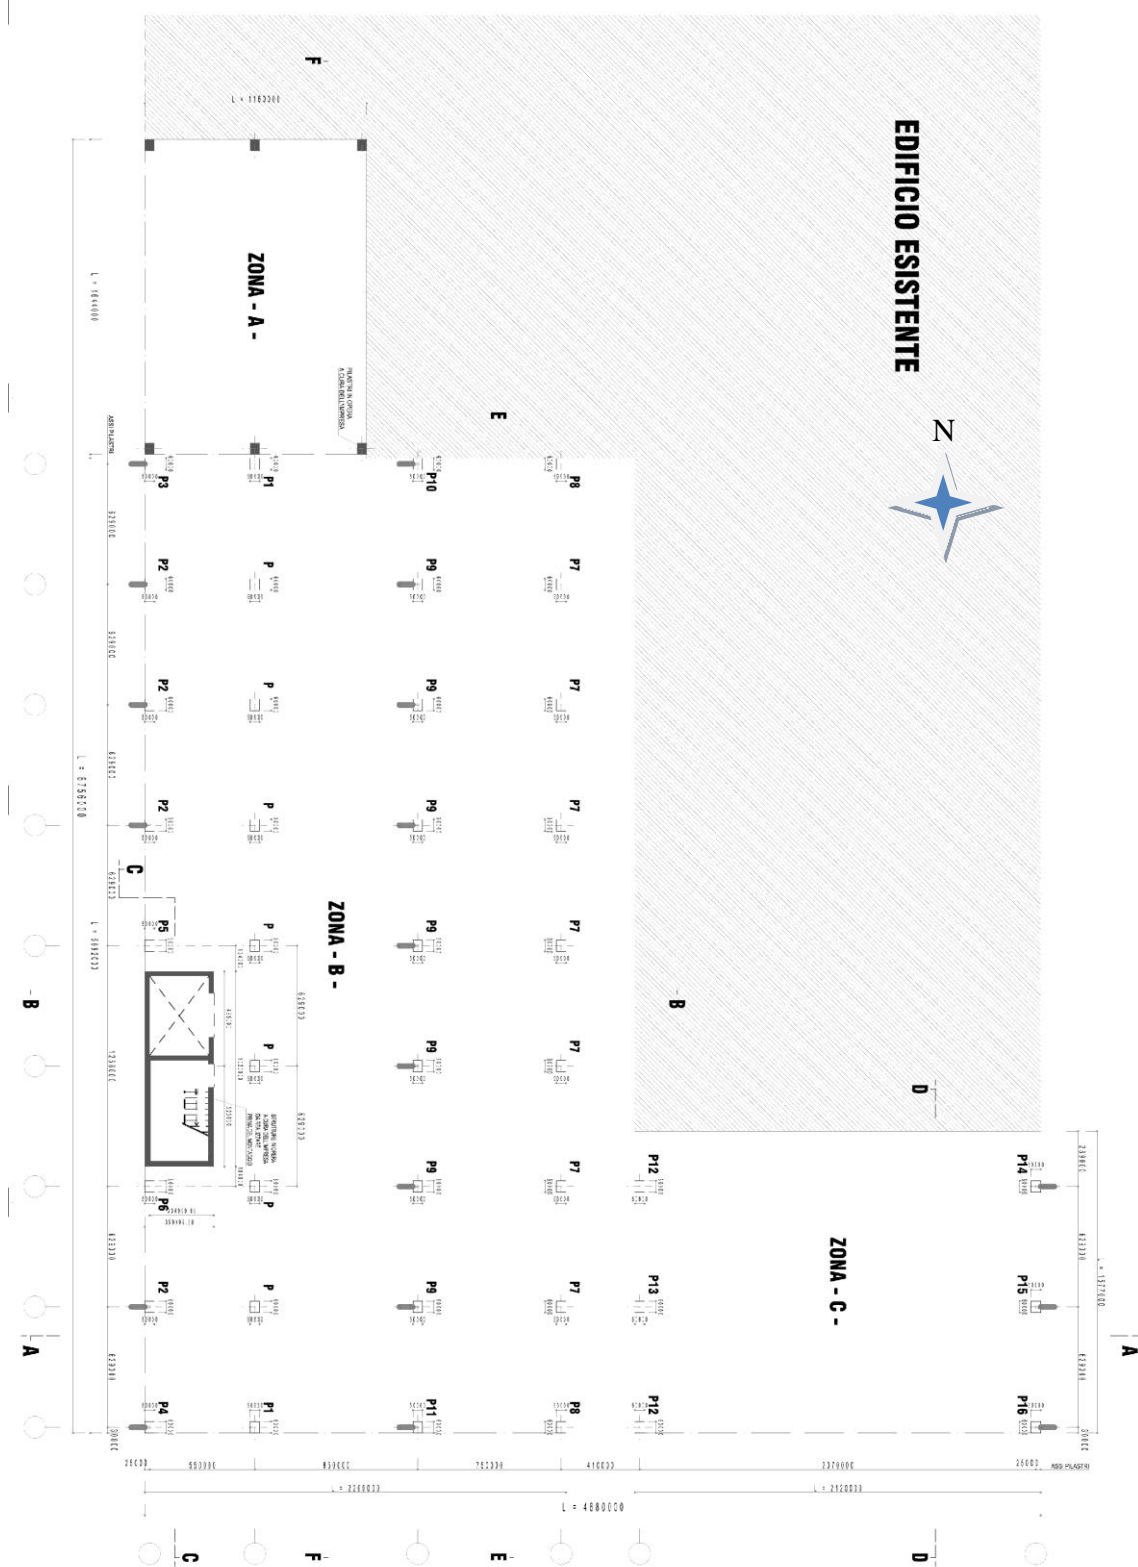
Particolare di A.2003.cap.us.T14 - Pianta pilastri
